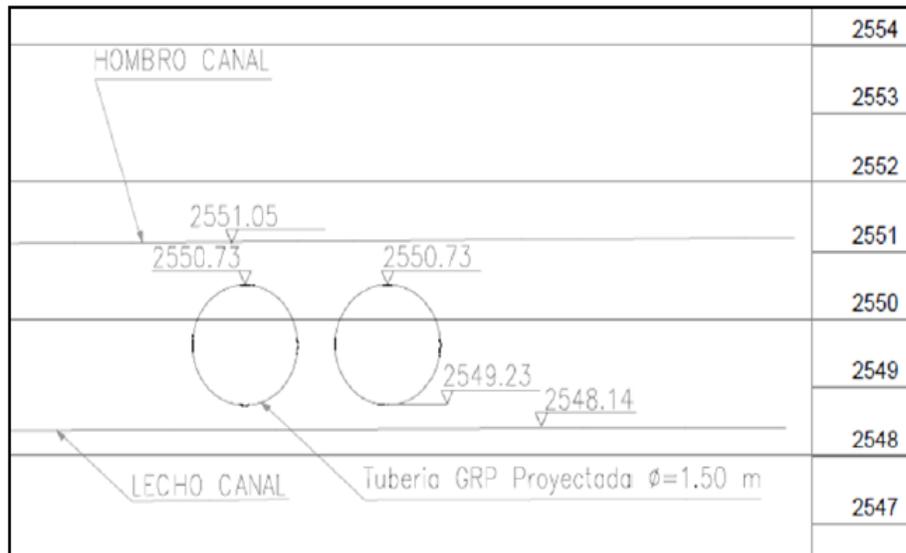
Vista transversal de la tubería occidental de 1.50 m a instalarse en el canal Torca.
